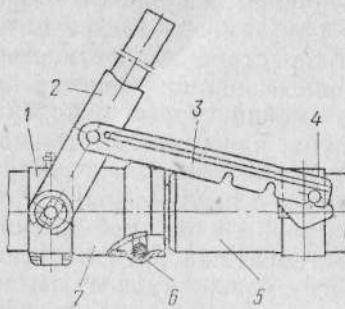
Стыковочное устройство для монтажа труб враструб на резиновых кольцах
